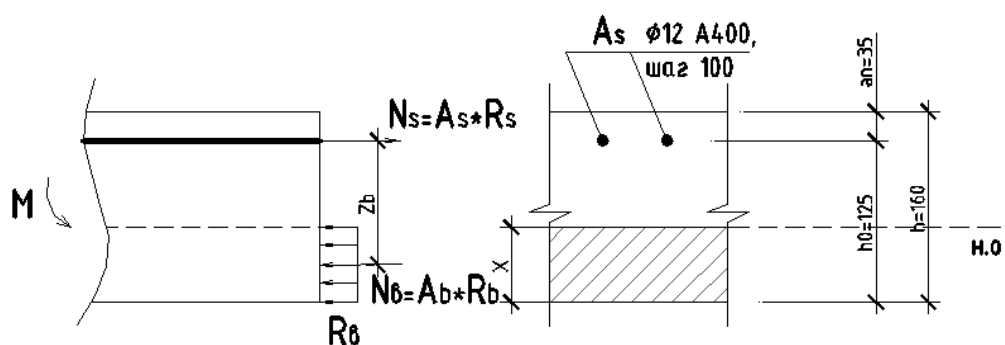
Схема внутренних усилий плиты на опоре
